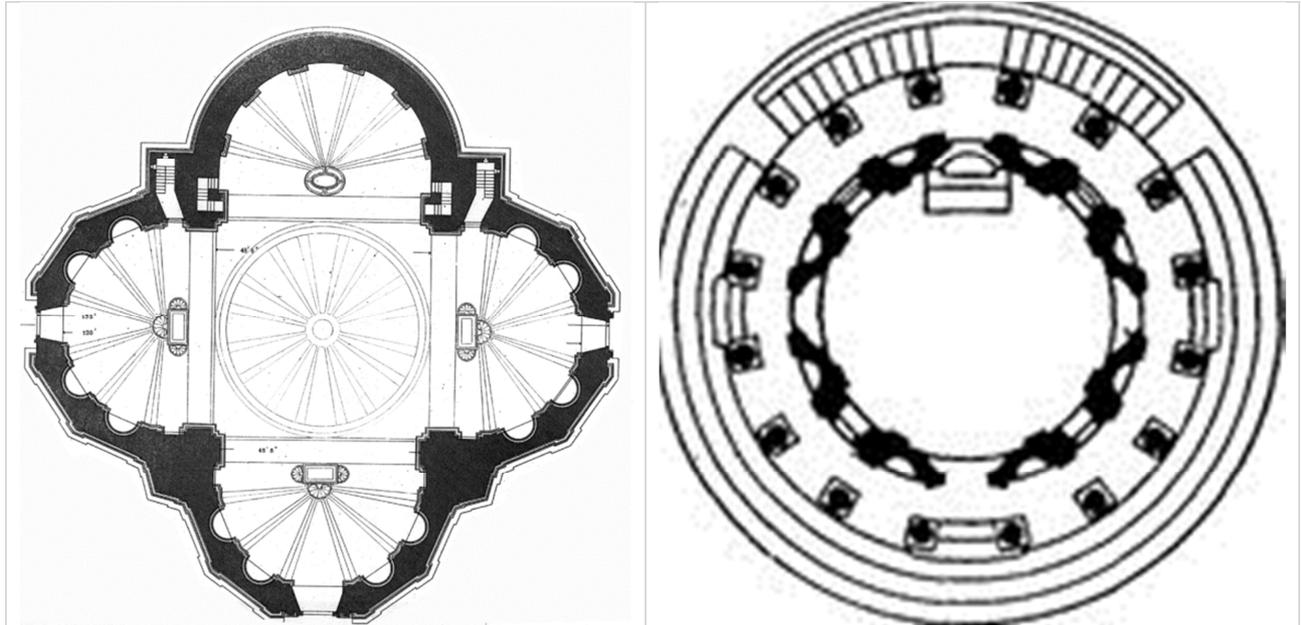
, izquierda: Planta de Santa Maria della Consolazione. Fuente de la imagen:
